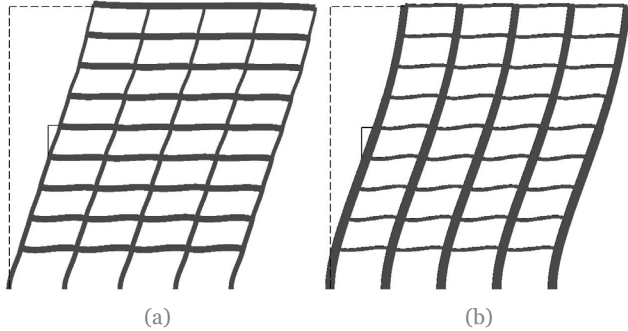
Deformada sísmica típica para pórticos con vigas de canto (a) y vigas planas (b) proyectados según EC8 en ductilidad alta (27).
